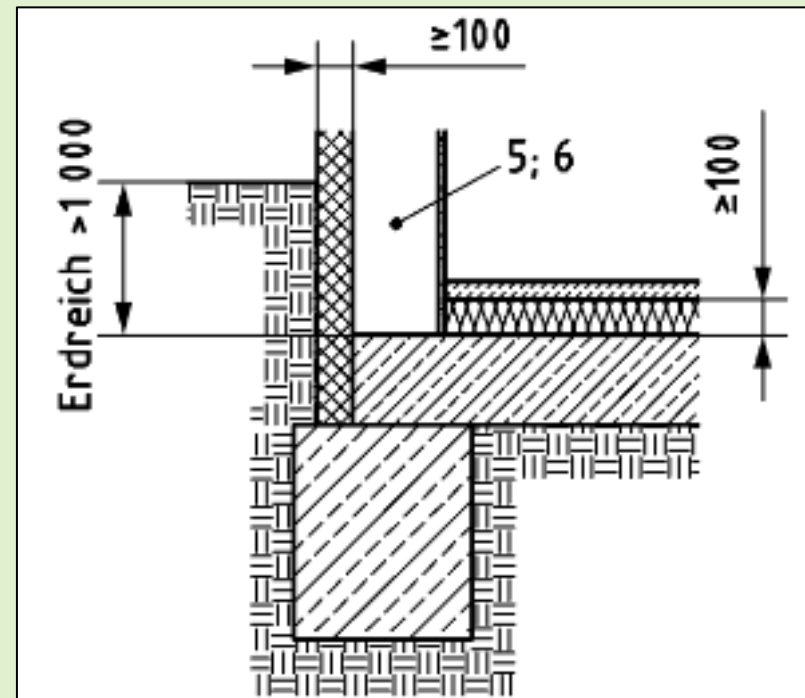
Anschluss Kelleraußenwand auf Bodenplatte
